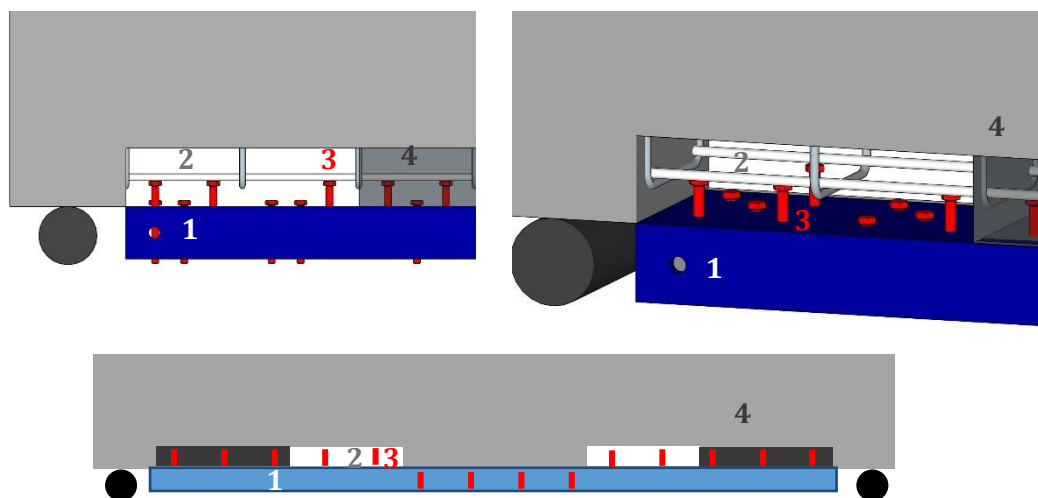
Secuencia constructiva del refuerzo propuesto.
